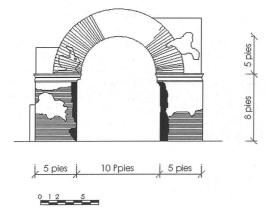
Alzado de la portada principal de la iglesia de Túcume Viejo. Levantamiento planimétrico Antonio Vela Cossío, arquitecto
